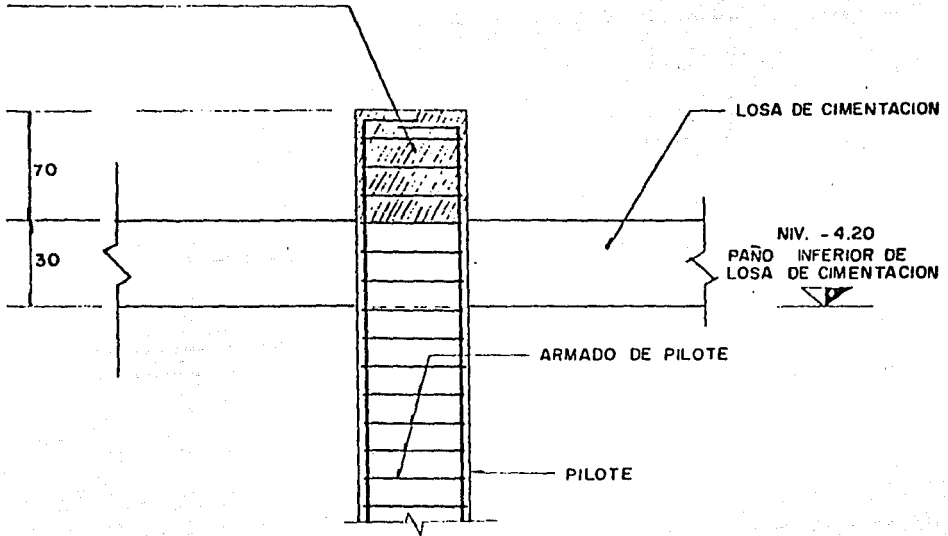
DETALLE TIPO DE ANCLAJE DE PILOTES EN LOSA.
